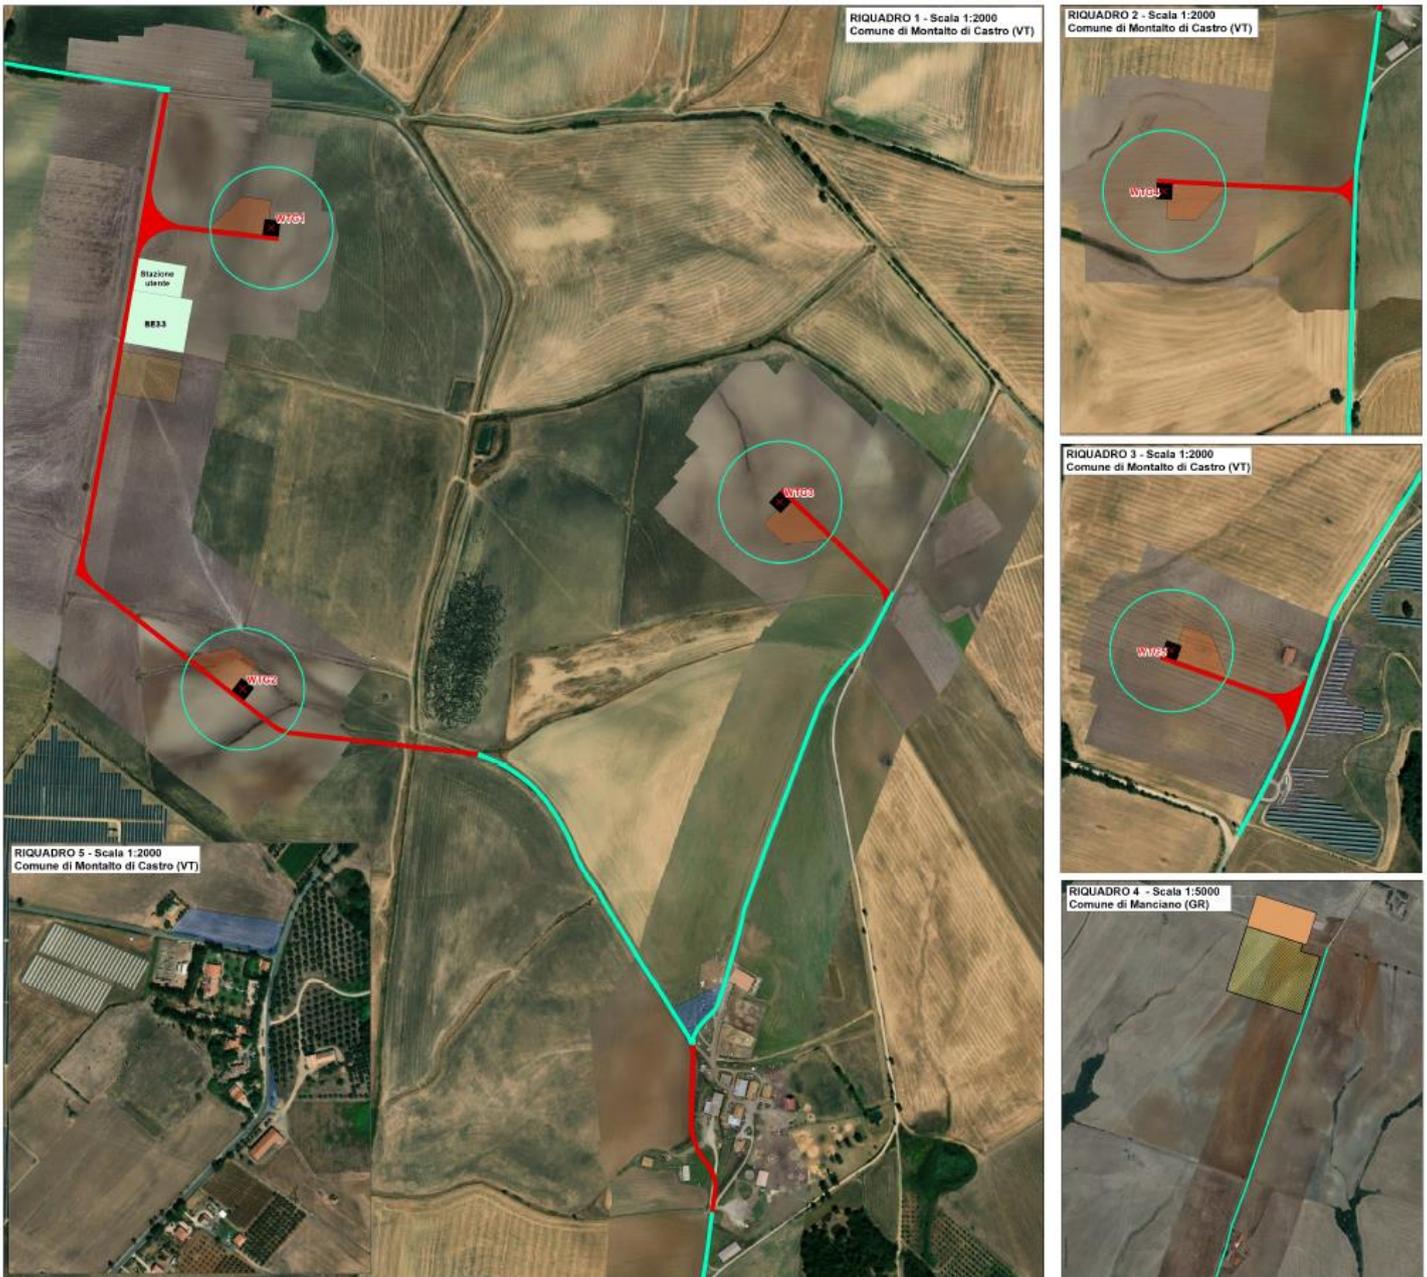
Layout di progetto (SKI36-MCAS-CTR_Planimetria generale viabilità)
